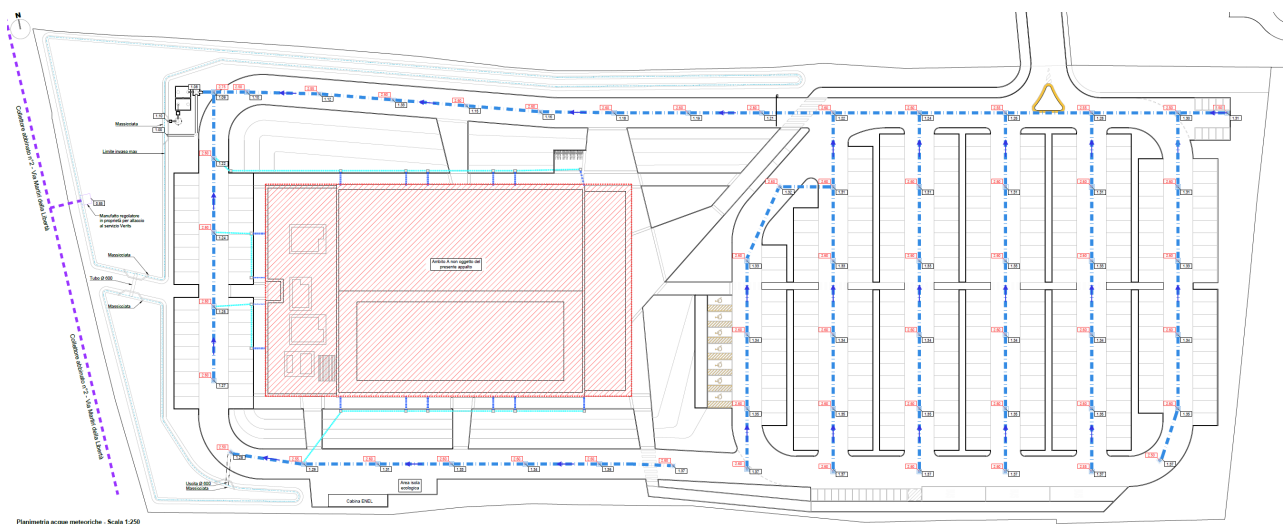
planimetria di progetto del sistema di smaltimento acque meteoriche e laminazione
